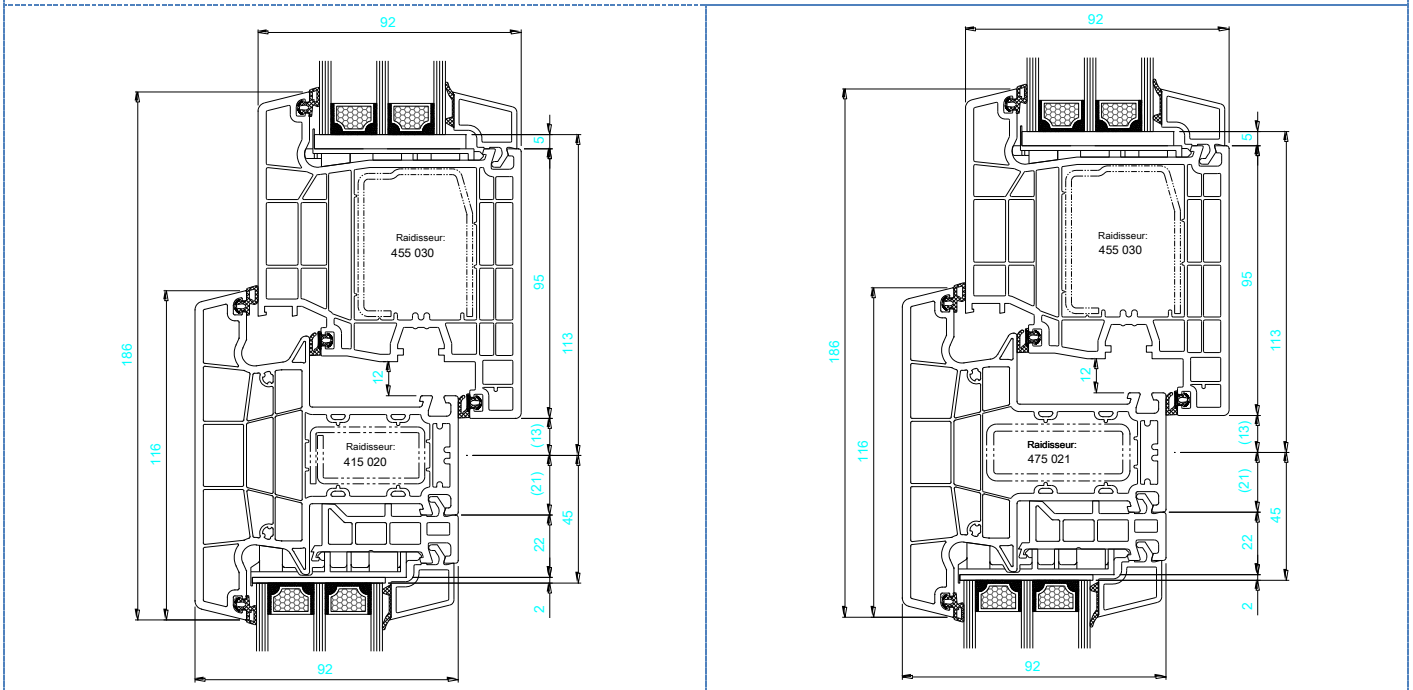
(suite) – Ouvrant avec meneau et fenêtre fixe
